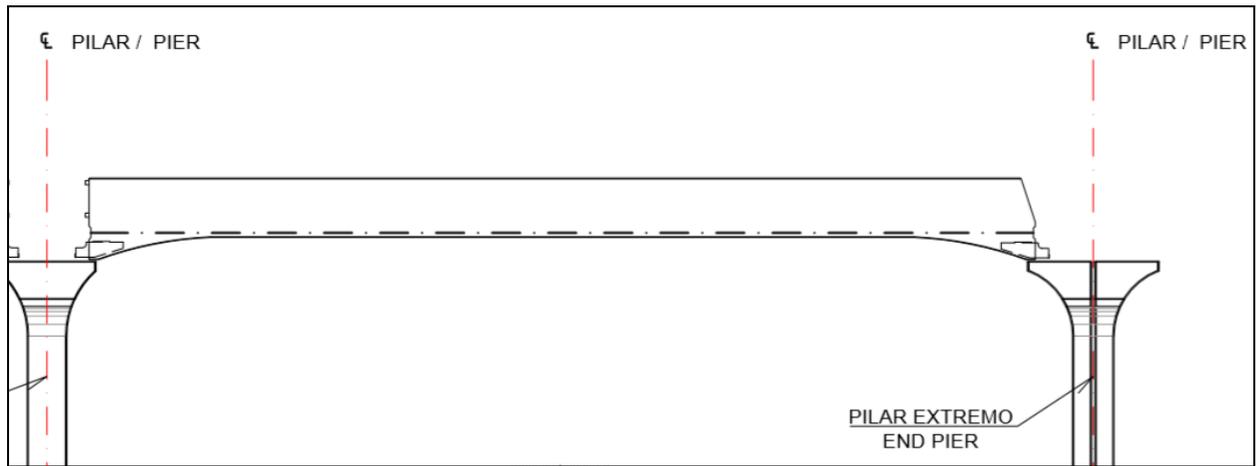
Perfil da viga apoiada nas travessas.
